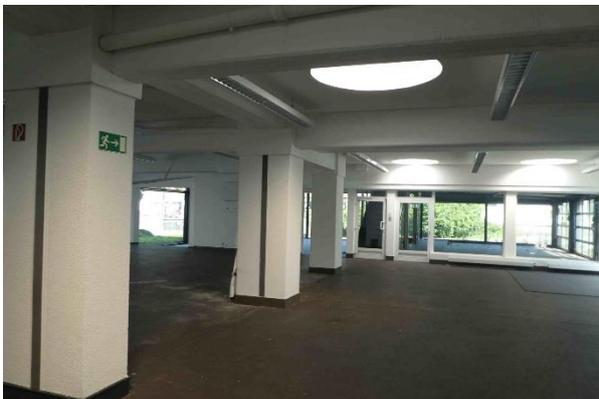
Ausstellungskomplex des Autohauses im EG, hinten Anbau
